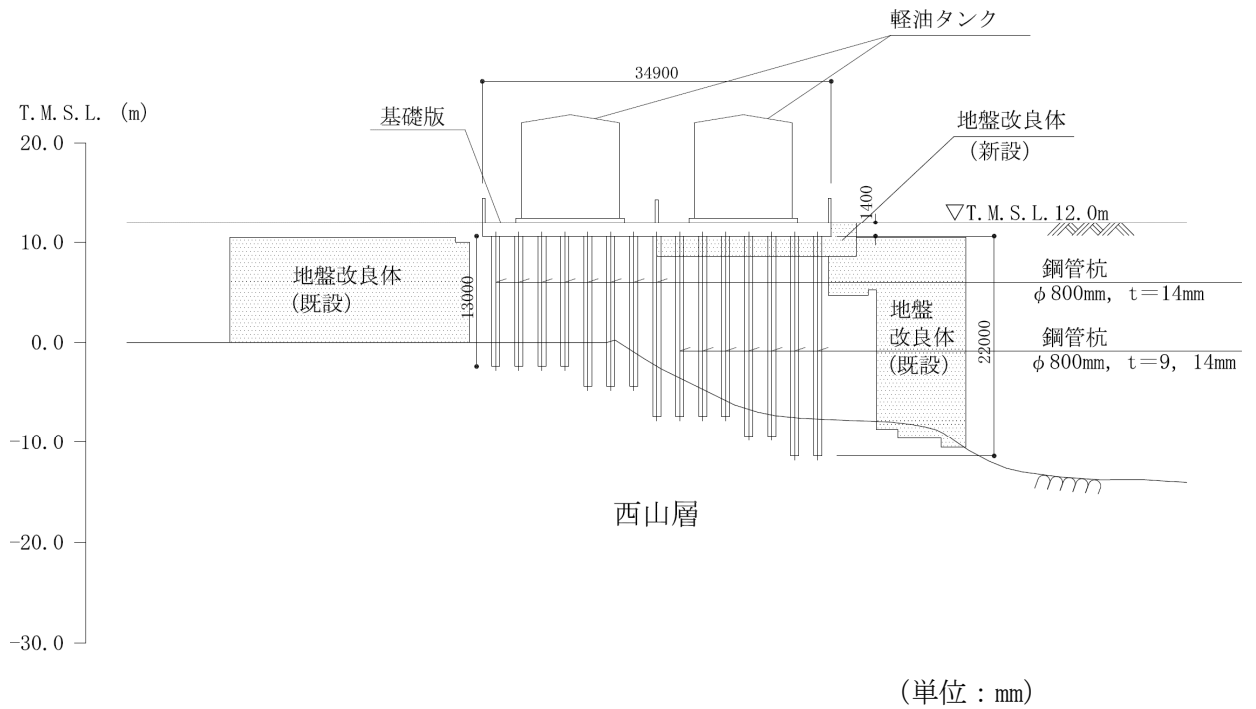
(2) 軽油タンク基礎の断面図 (B-B断面)
